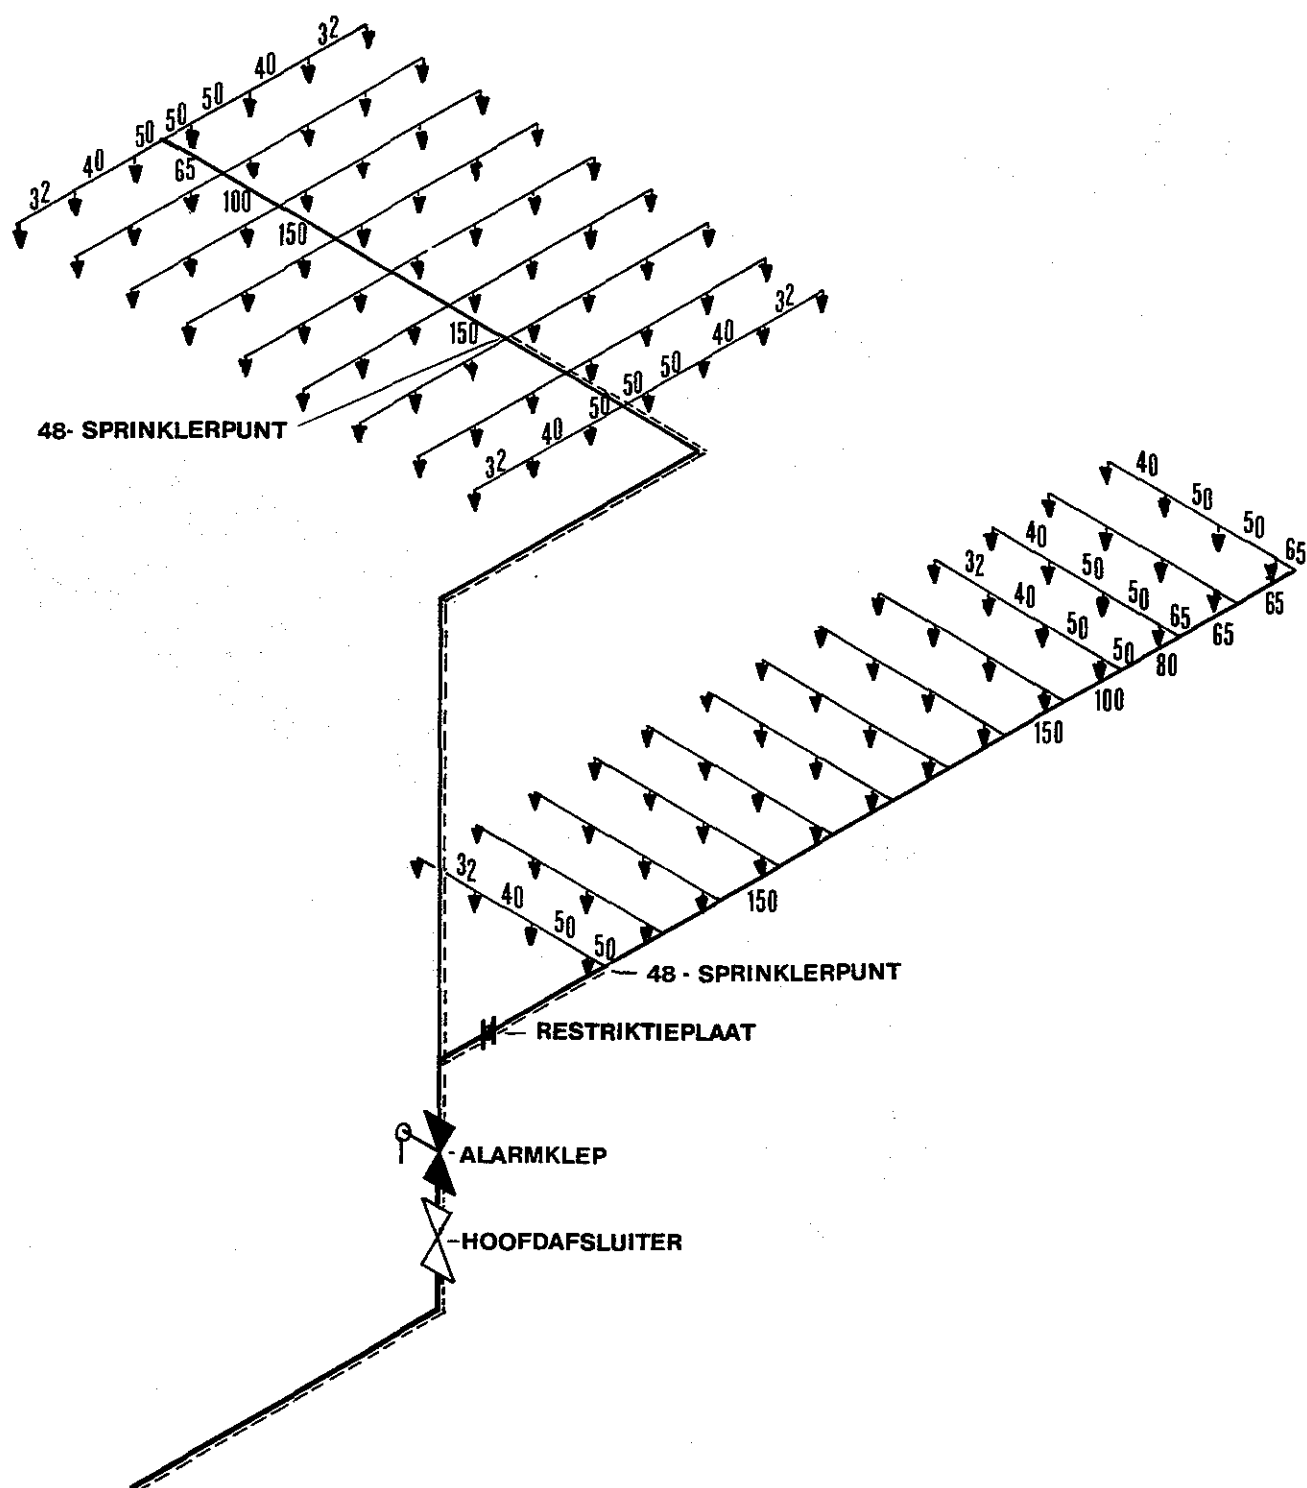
voorbeeld van een sprinklersekte van een sprinklerinstallatie klasse H, volgens tabel 26A en 26B
